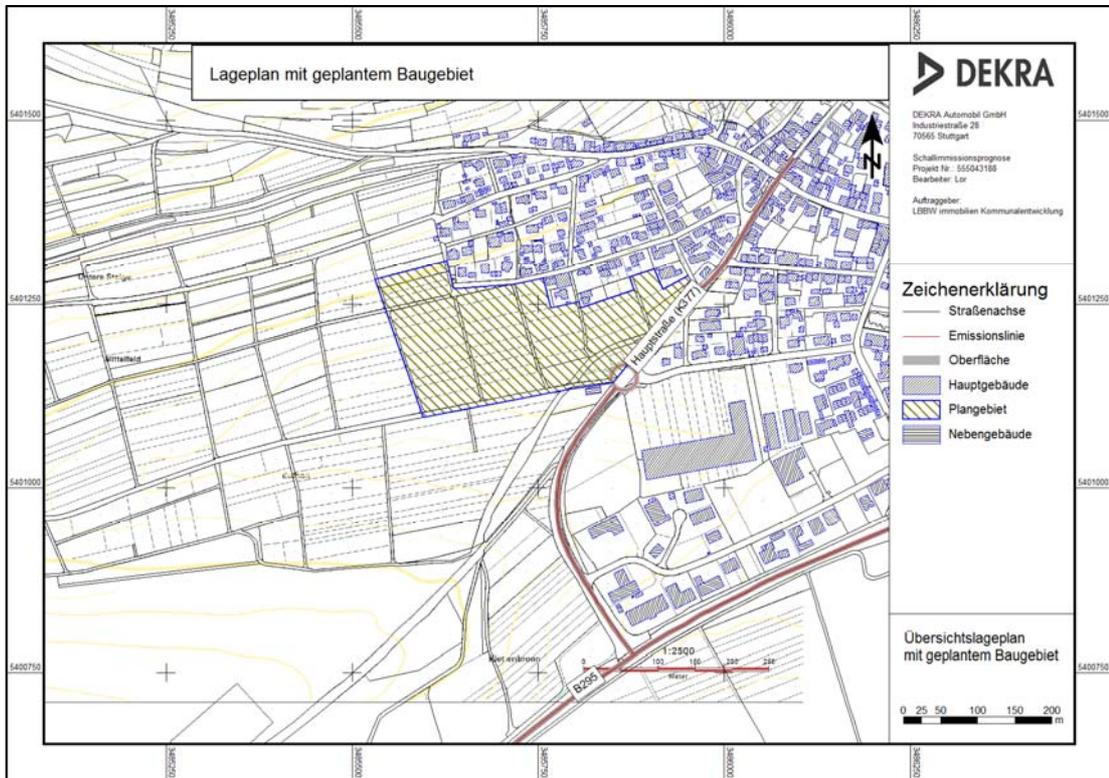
Lageplan mit geplanten Baugebiet und den 2 berücksichtigten Straßen
